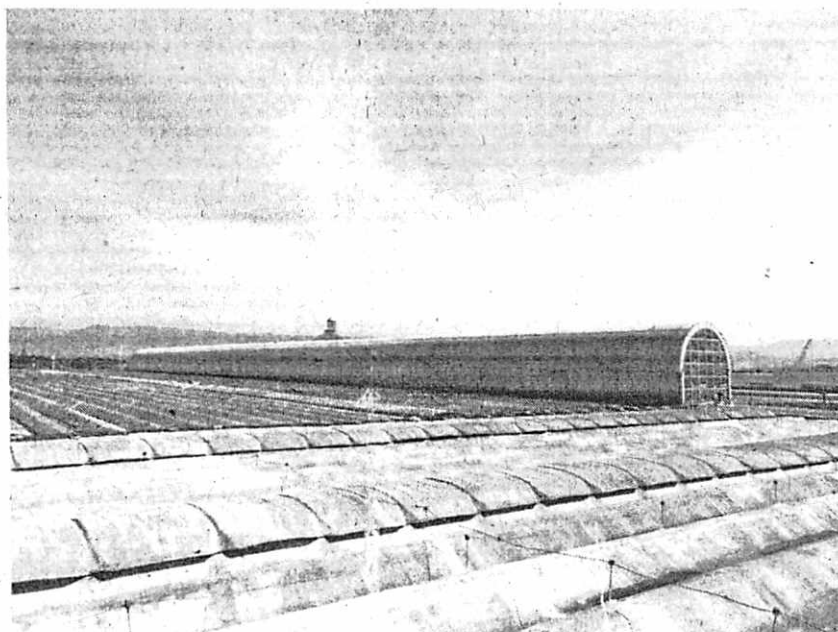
Vista geral do telhado do supermercado que faz parte do conjunto do shopping center.
